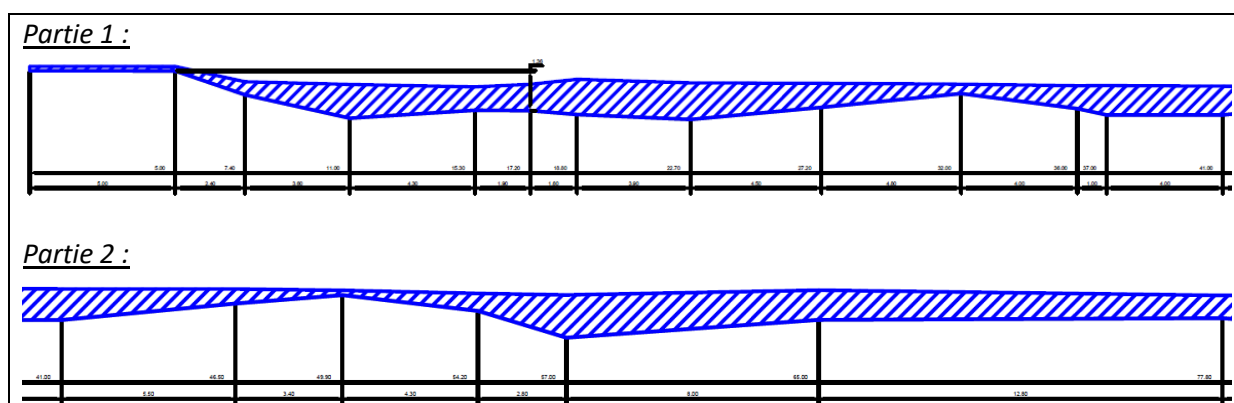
Plan de maîtrise d'œuvre pour le site de Théligny — en mètre (Auteur : Illona Doyon)
